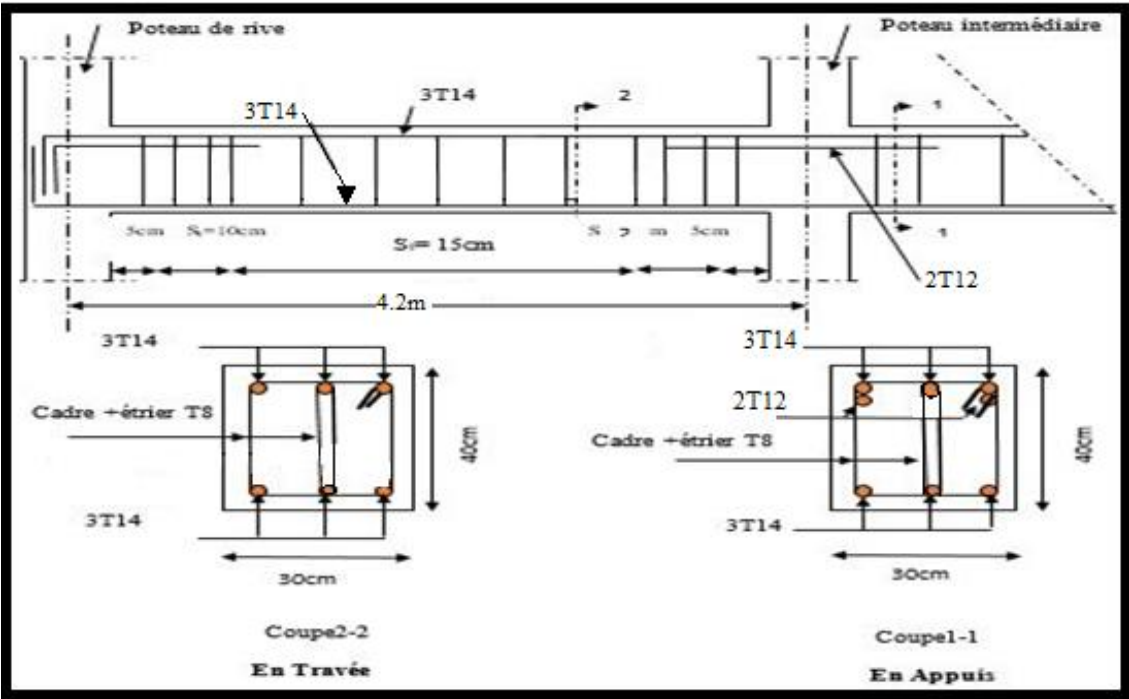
schéma de ferrailage des poutres principales nonassociées au voile.
